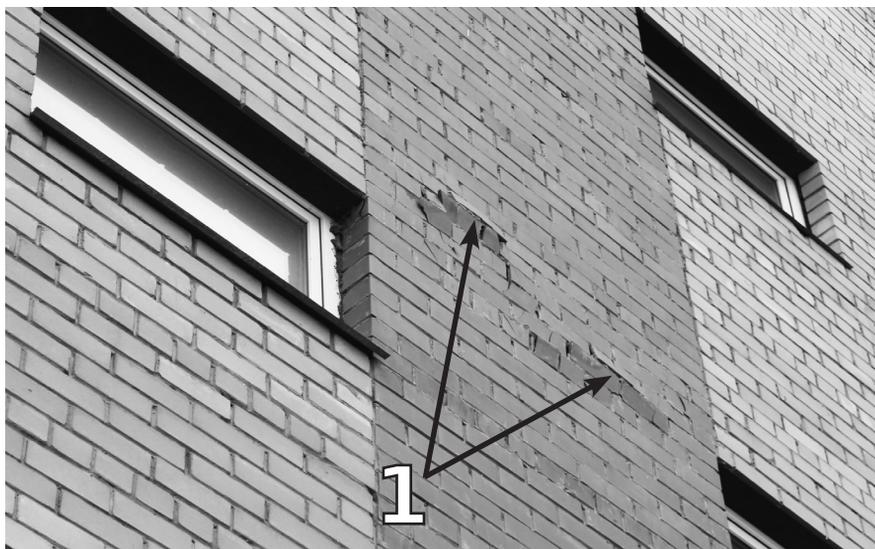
Фрагмент фасада в уровне подоконника окна 4-го этажа, (кладка 1982 г.): 1 – значительный выпор наружной версты кладки подоконного участка стены; 2 – выпор наружной версты.
